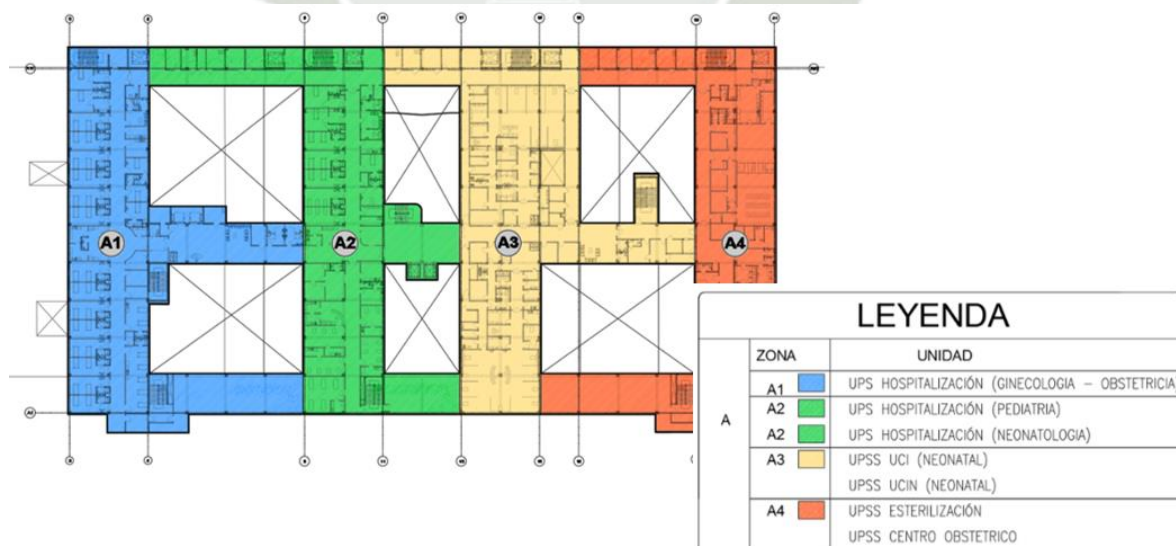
Plano de Planta con Sectorizaciones Tercer Nivel
